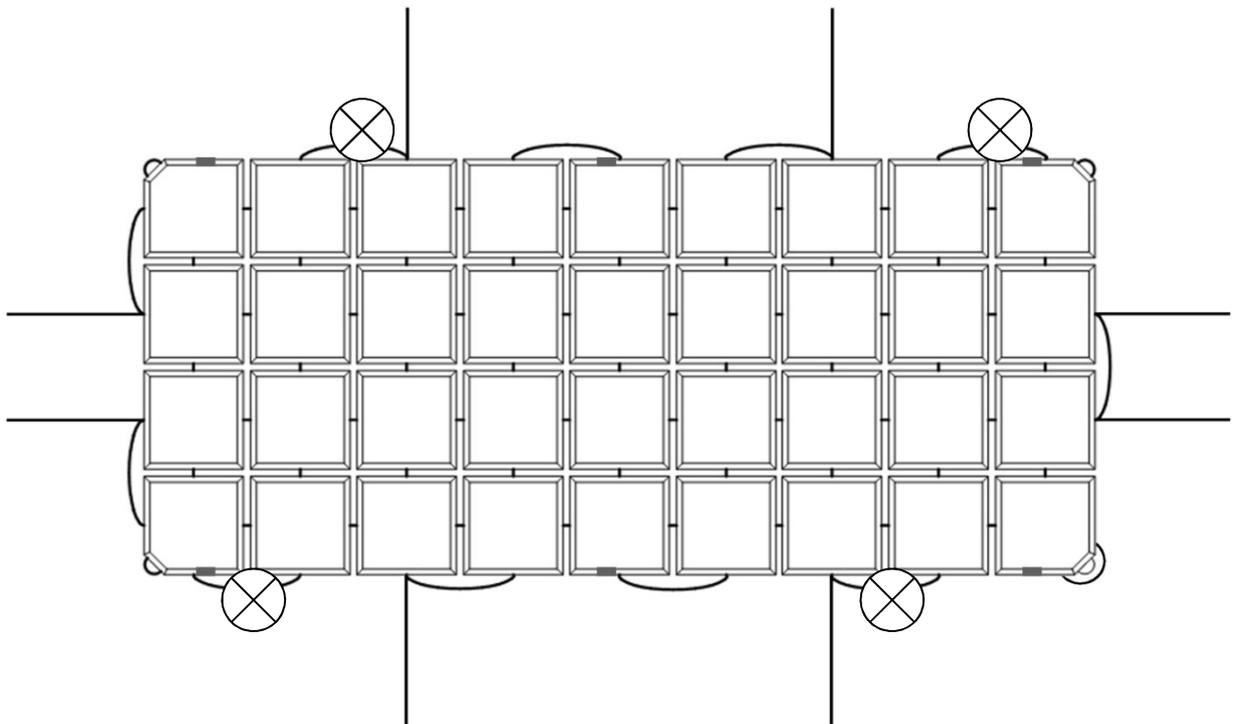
Места строповки гибкой бетонной плиты за четыре петли
